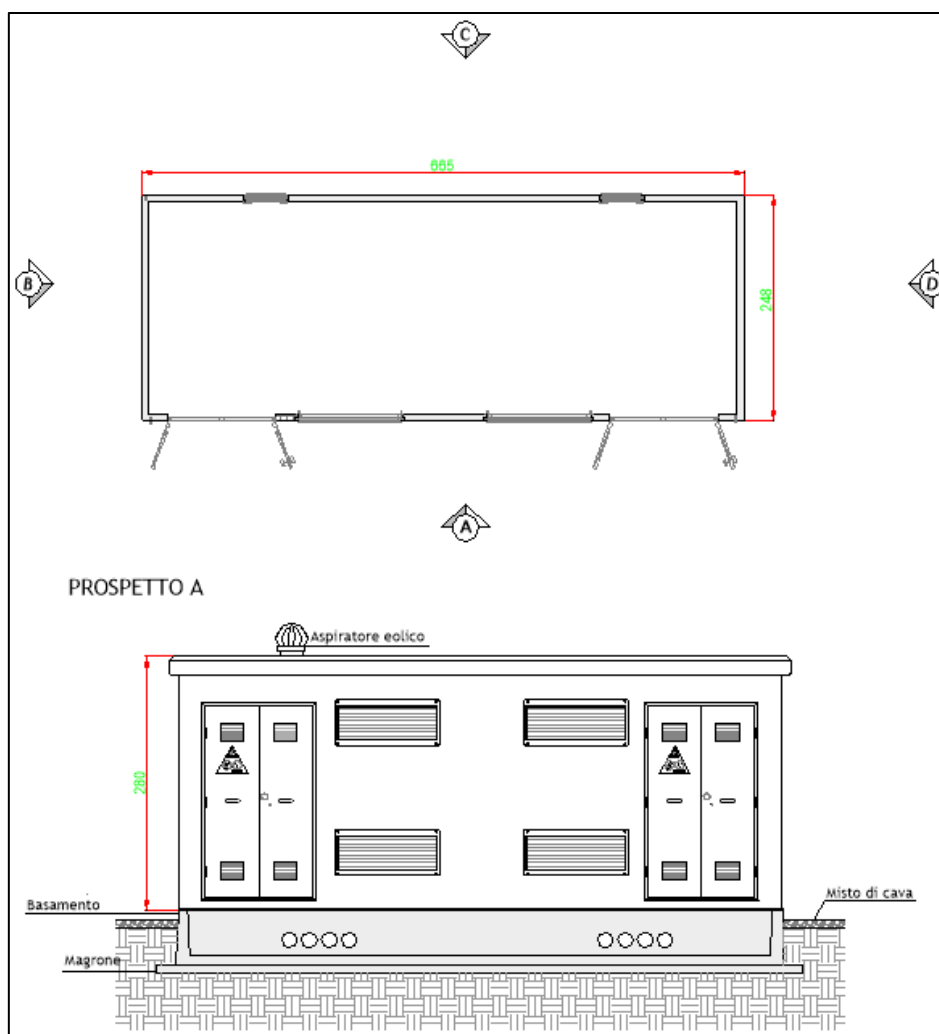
Planimetria e prospetto della Cabina Inverter e Cabina di Raccolta R2/3/4
